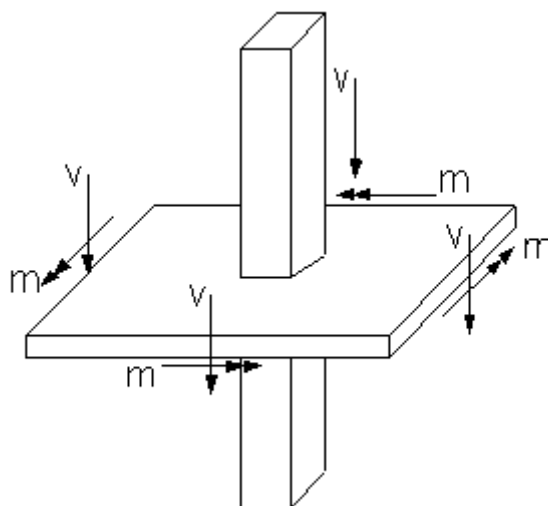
Transferência de forças e momentos entre o pilar e a laje
